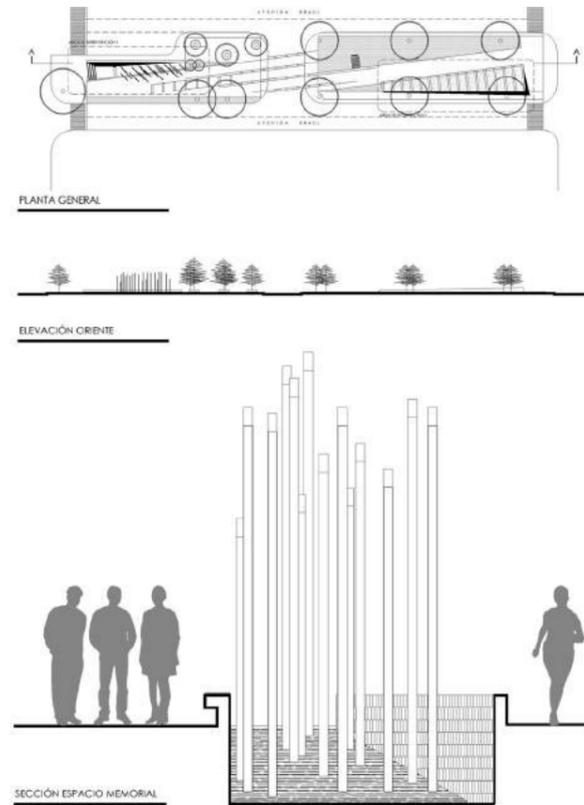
Planta, elevación y sección Parque De La Meditación De Chillán
